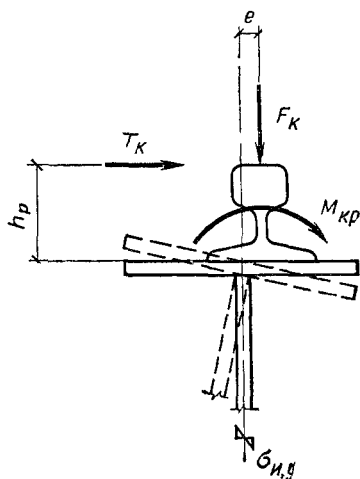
Схема действия вертикальной и горизонтальной сил на подкрановую балку
